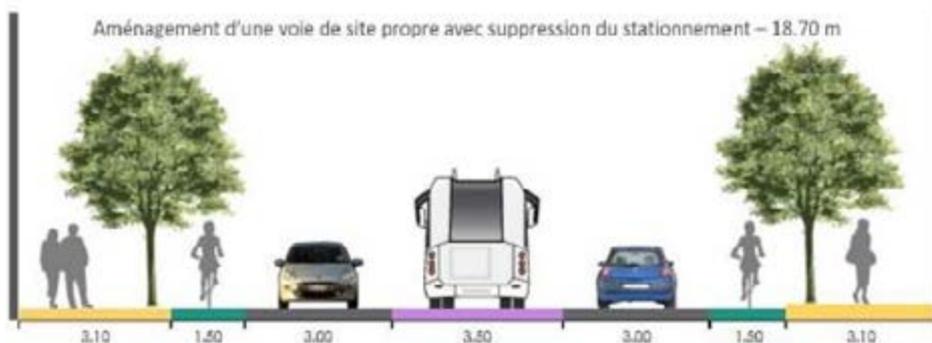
Variante – Aménagement d'une voie de site propre avec suppression du stationnement
